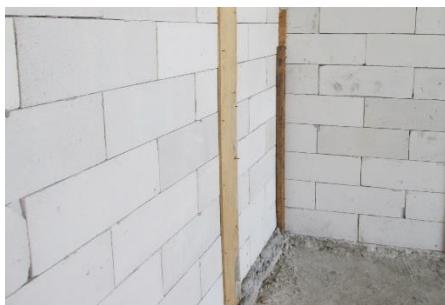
5 Contoh Lantai Alternatif 4 (A4)
